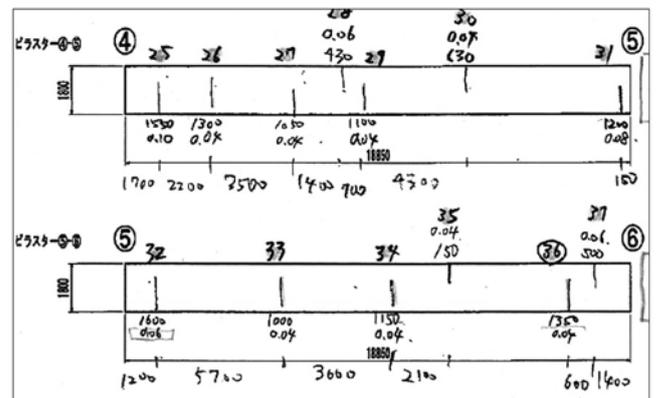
ひび割れ発生記録票 (7リフト一部抜粋)
